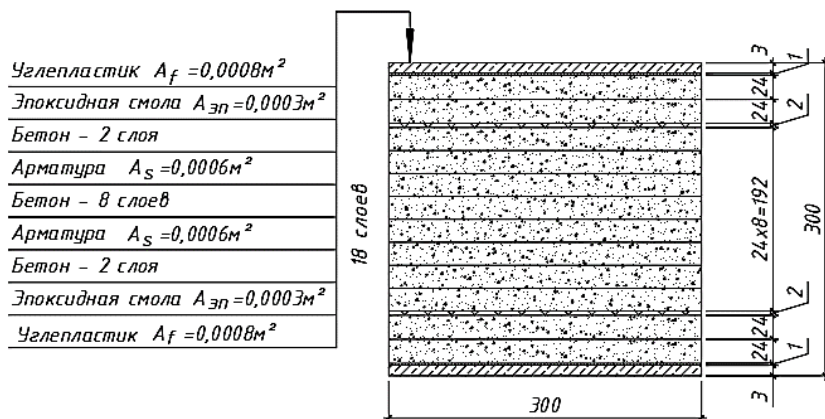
Расчетная схема поперечного сечения нижнего пояса ферм в виде слоистого материала в расчетной схеме № 3
